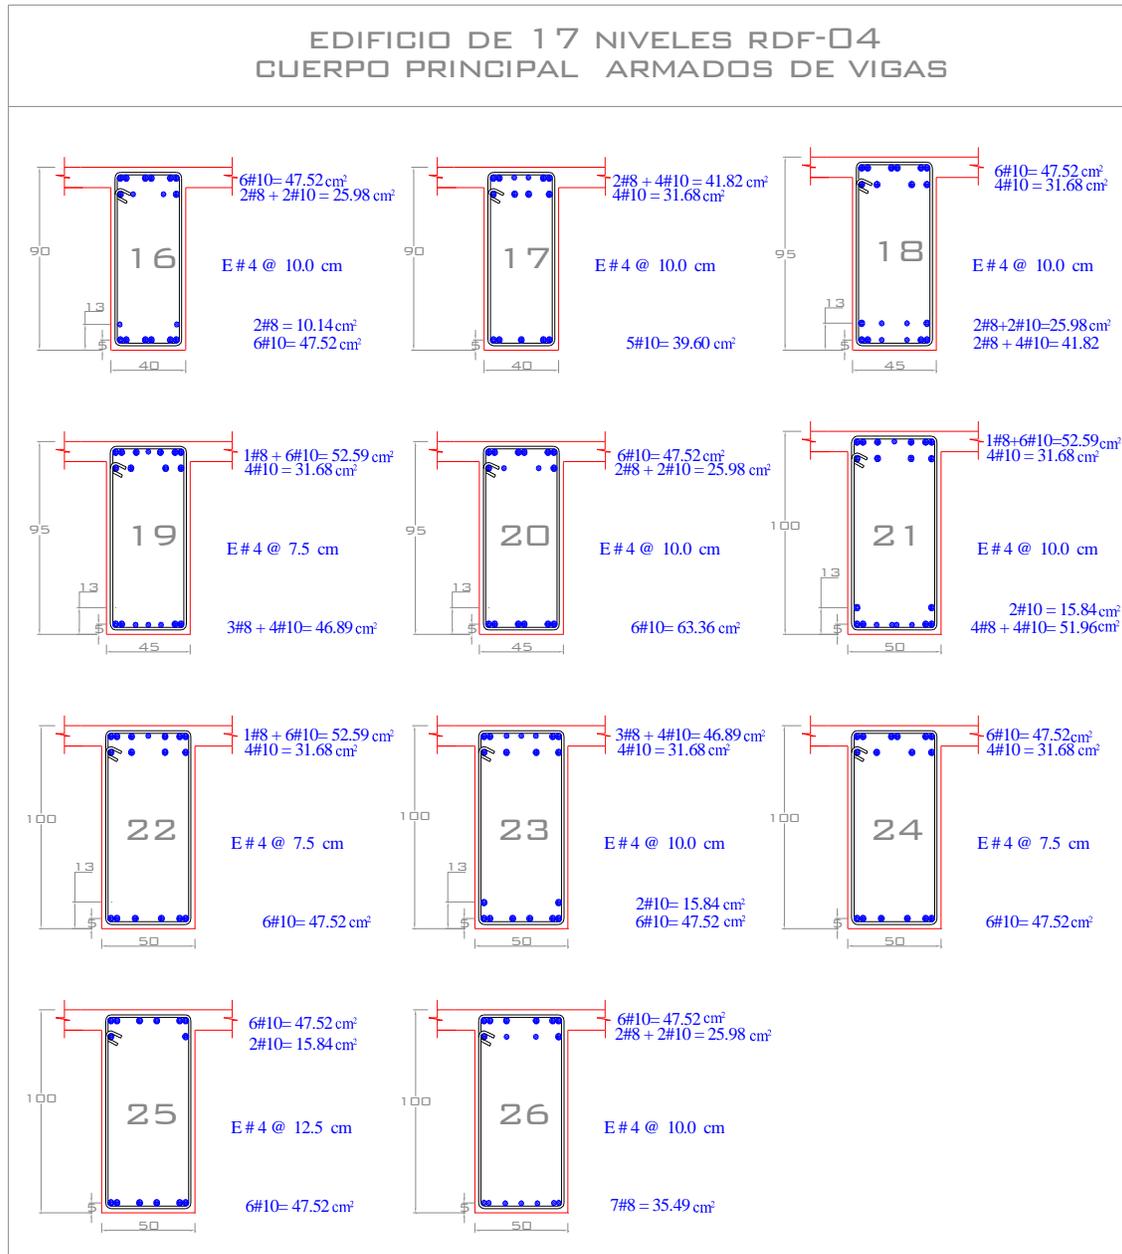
Armados longitudinal y transversal propuestos de vigas, edificio 17 niveles, Cuerpo Principal (caso A) de las NTC-Sismo, RDF-04
